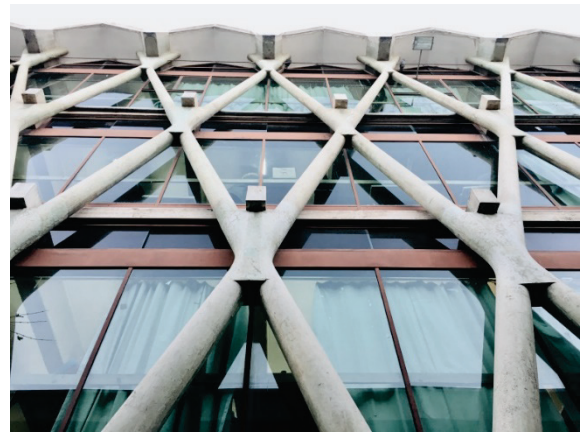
Fachada Sur. Remate coronamiento losas plegadas
